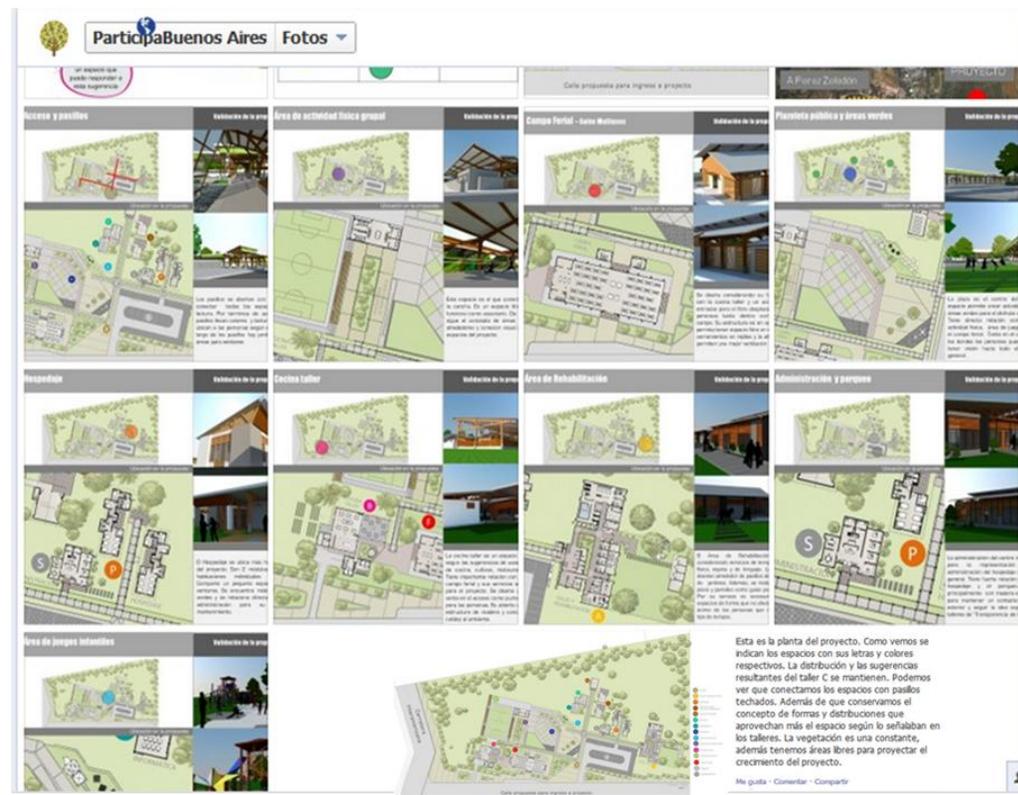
Publicación planta de conjunto y fichas de los espacios. Fuente: Elaboración propia.
